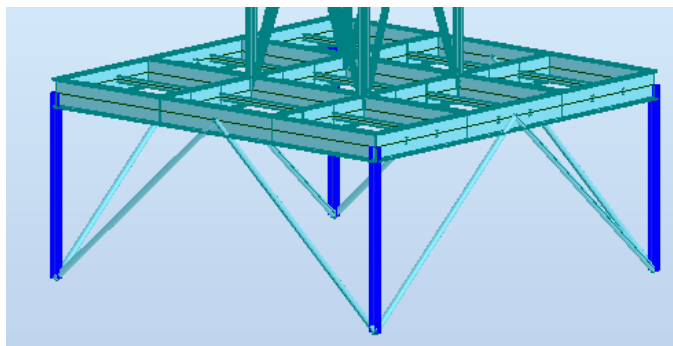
Barras dos pilares da estrutura metálica de suporte
